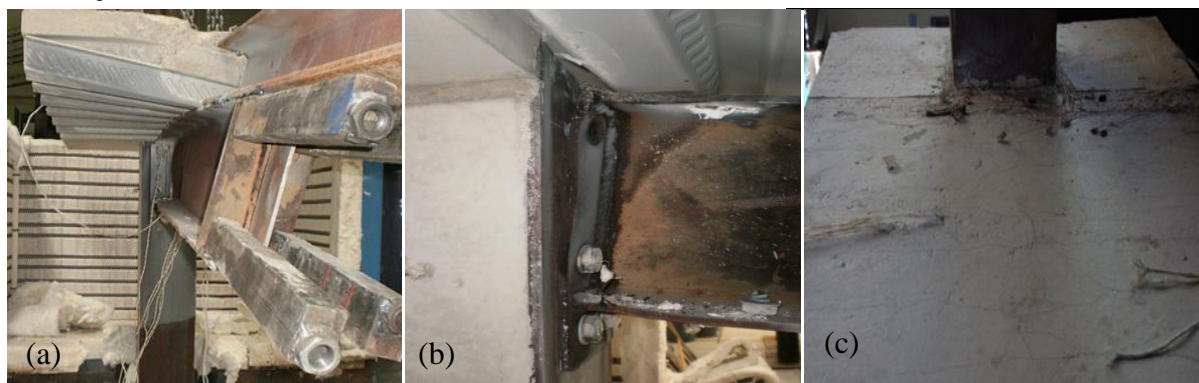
Deformação da ligação sujeita a situação de incêndio: (a) instabilização da viga, (b) rotura dos parafusos da primeira fila e (c) fendilhação da laje de betão.
